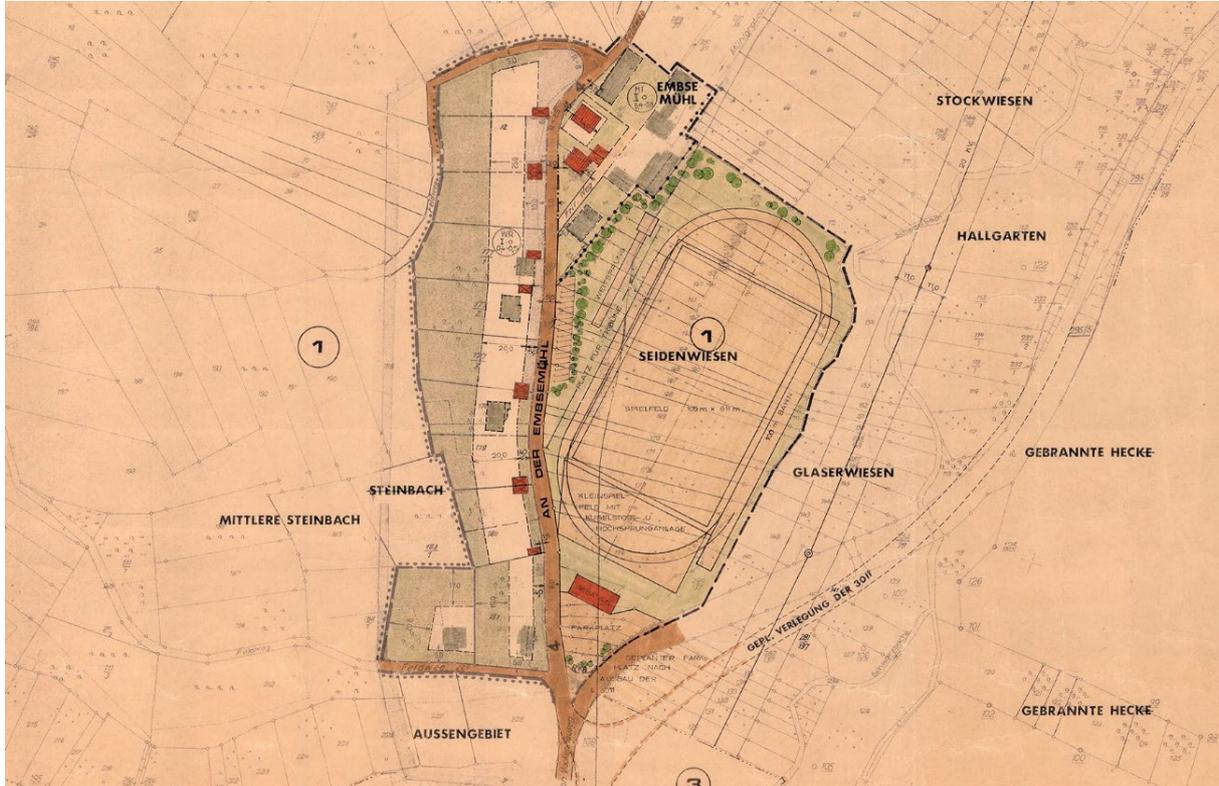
Bebauungsplan V 6 „Mittlere Steinbach“
